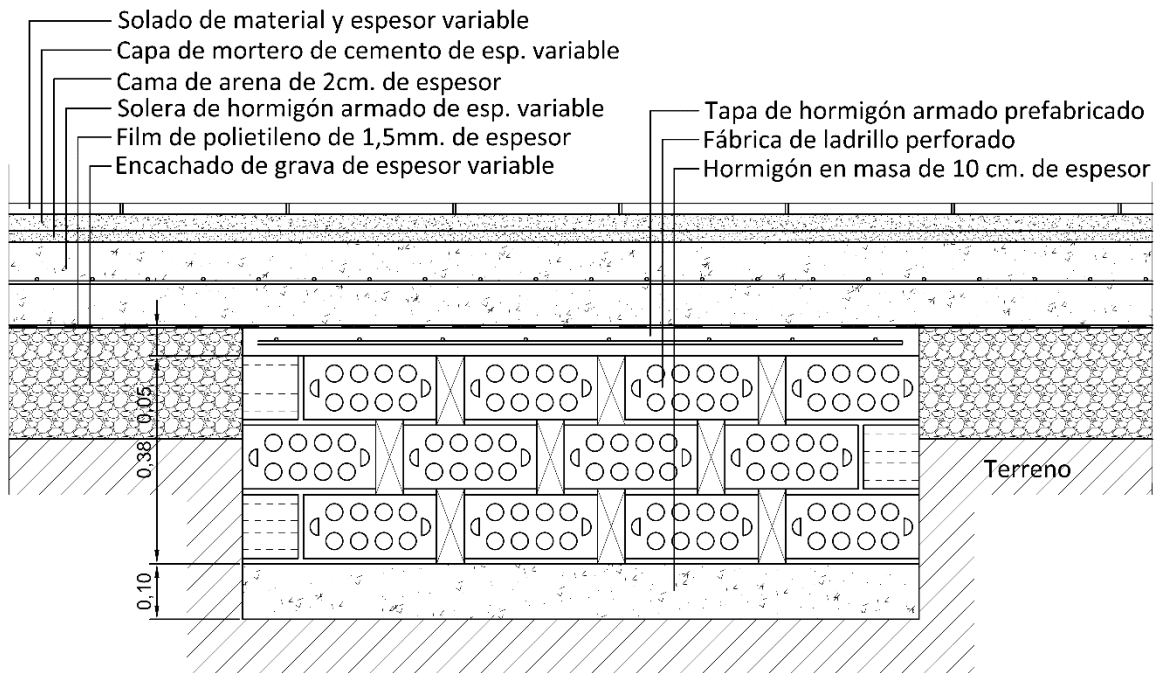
Sección A-A', detalle de arqueta de captación (SUMP) colocada bajo la solera de hormigón, cotas en metros y escala 1:15. (Elaboración propia).
